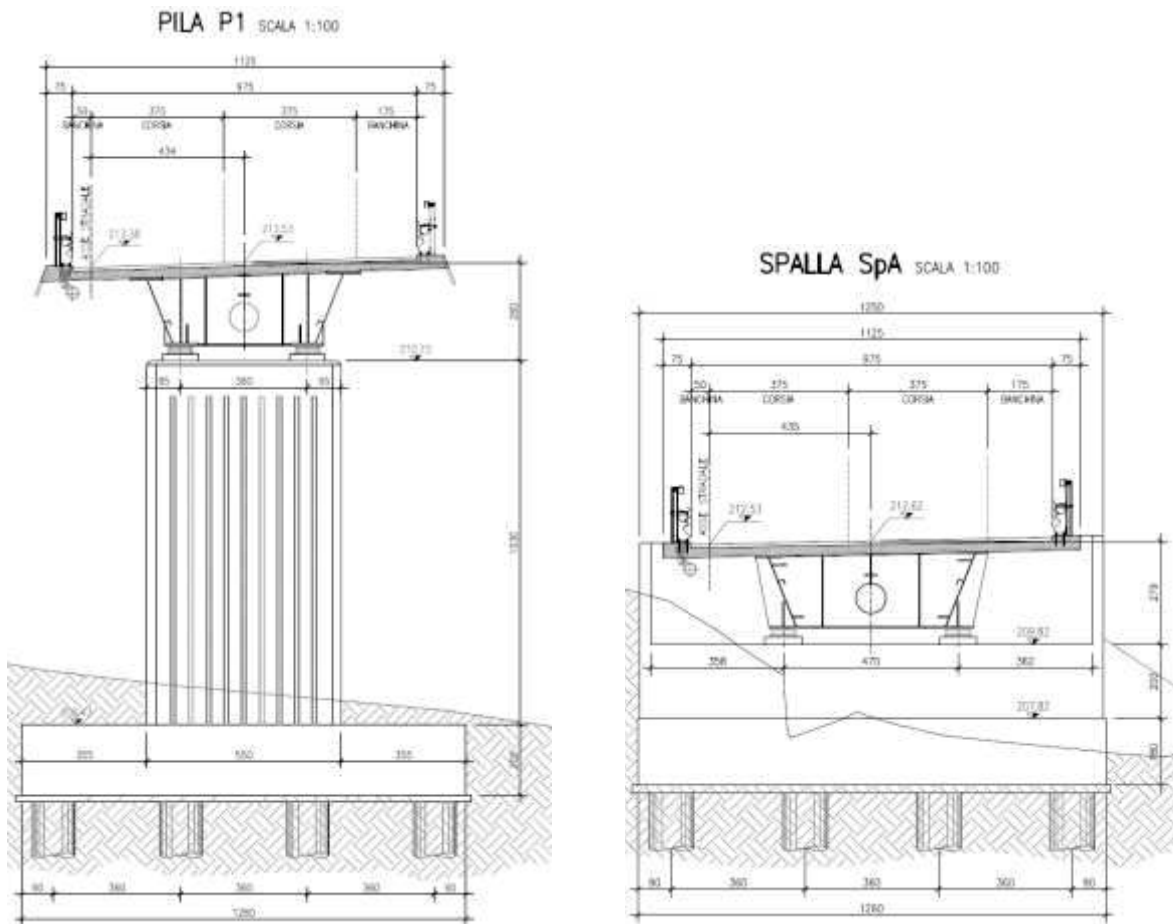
viste e sezioni principali – Sezioni su pila e spalla
